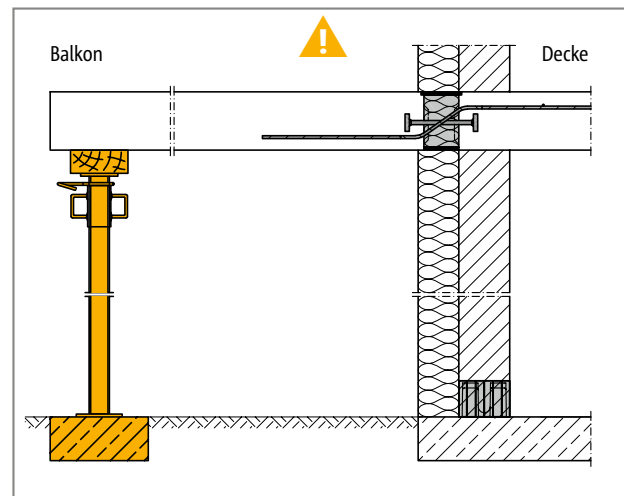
Schöck Isokorb® XT Typ QP: Stützung durchgängig erforderlich
